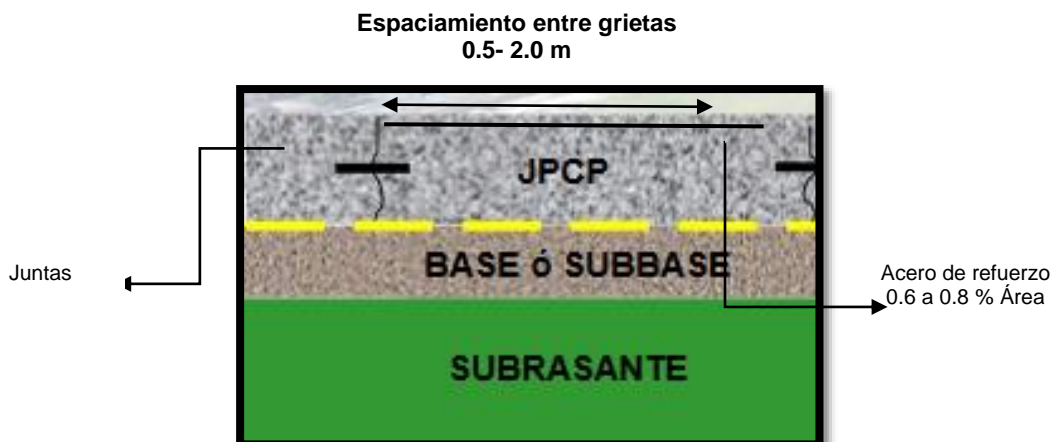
Pavimento de Concreto con Refuerzo Continuo (CRCP).
